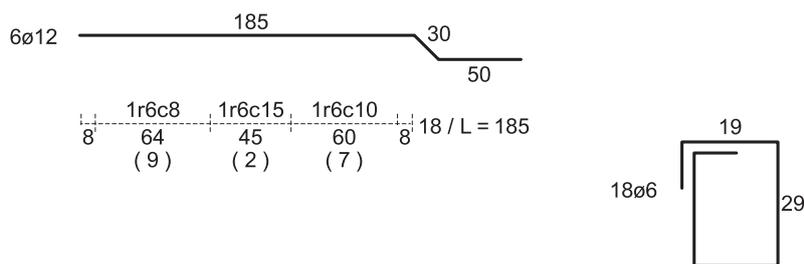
a Planilla del armado del pilar 14, forjado III, bloque III sobre la que se realiza la comprobación de las dimensiones de las armaduras de la ferralla
